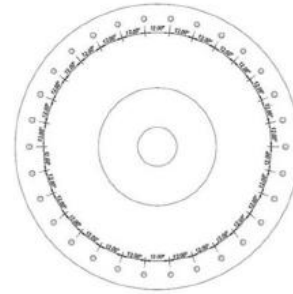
Andamento geometrico della fondazione (pianta - non in scala).
